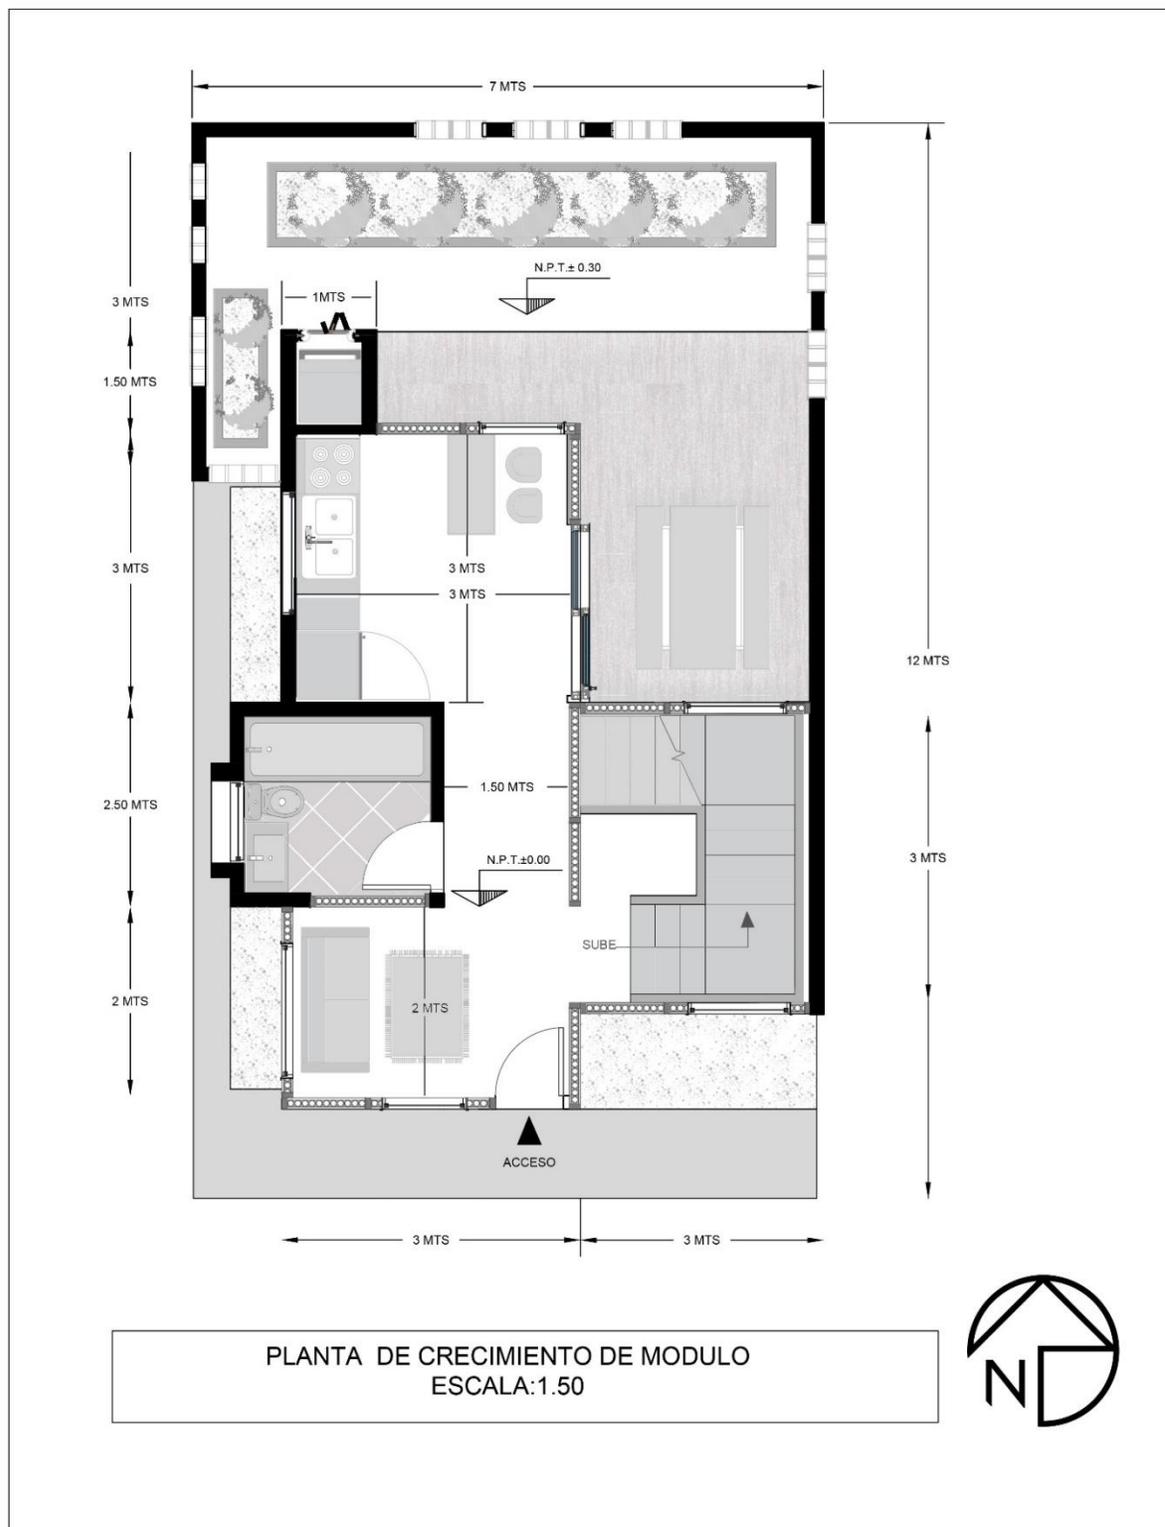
Planta arquitectónica prototipo unidad básica 2
